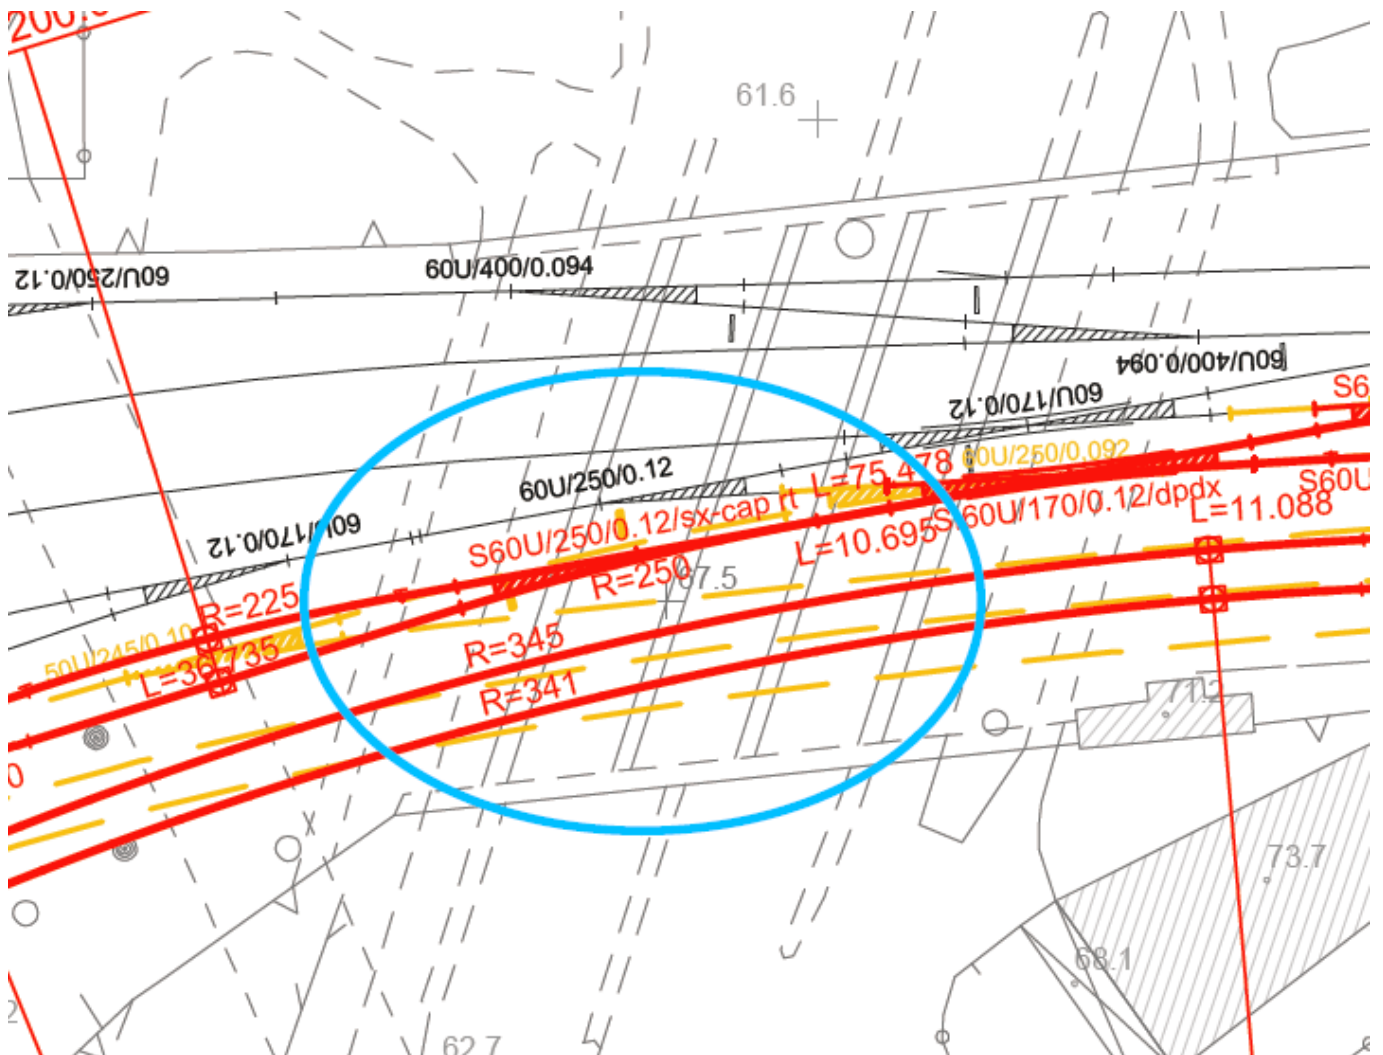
Planimetria dell'intervento del sottovia ferroviario, situato in corrispondenza del km 144+851
